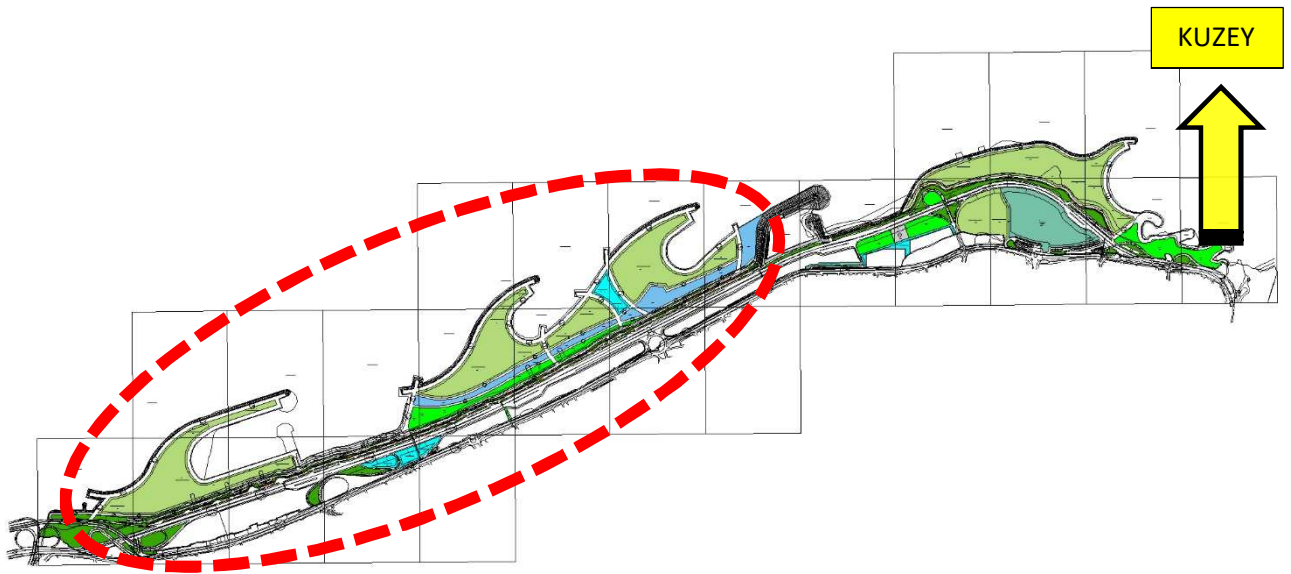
Çevre Düzeni Planında Planlama Alanı ve Çevresi
